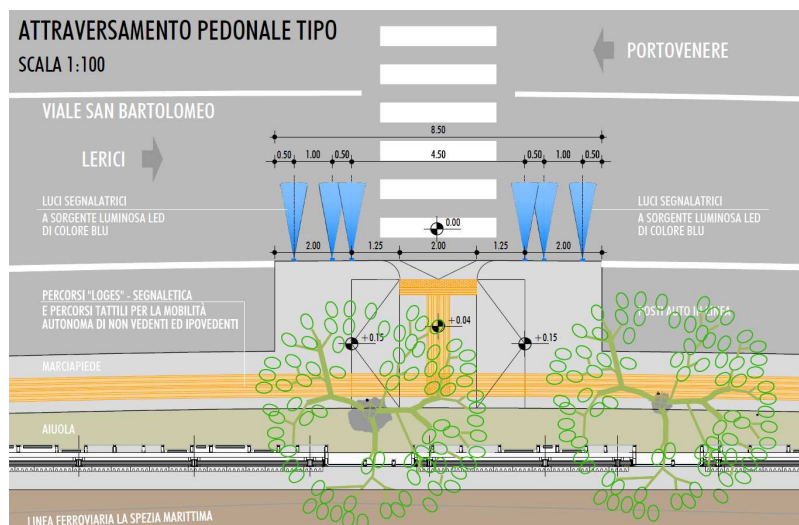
Particolare attraversamento pedonale con illuminazione a Led
